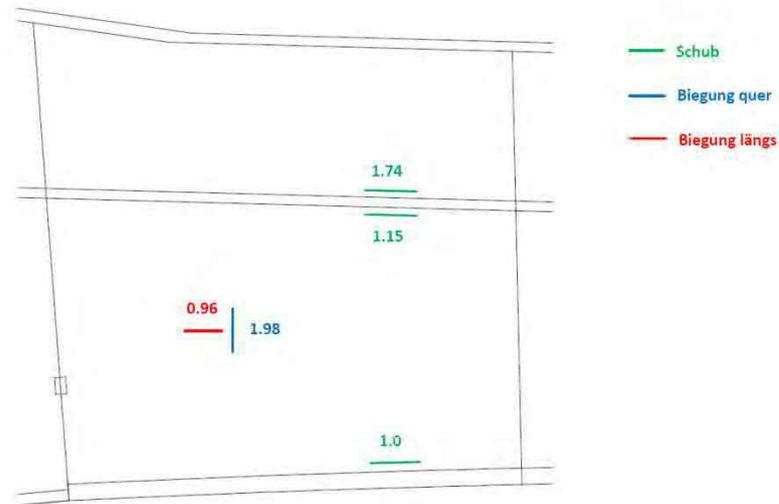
Nachweisführung für bestehende Decke Feld VIII
